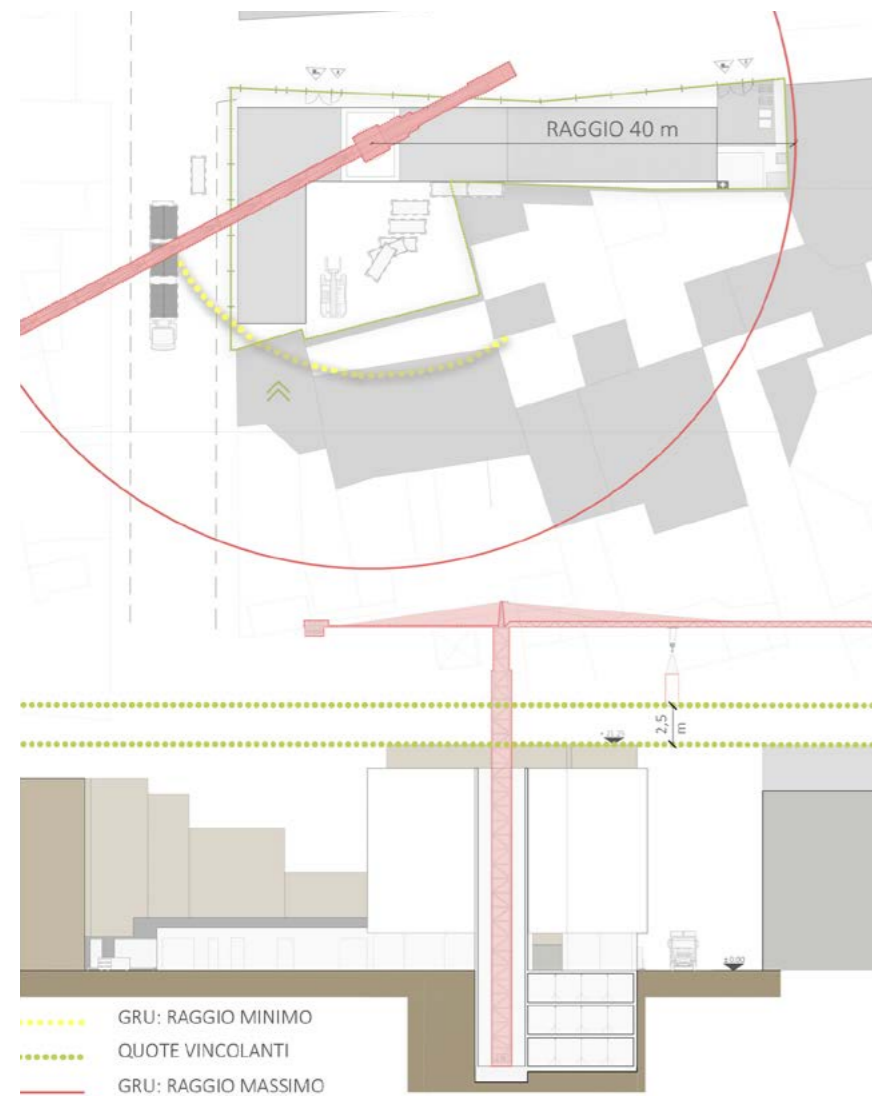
Planimetria e prospetto della gru di cantiere in relazione con il contesto.
